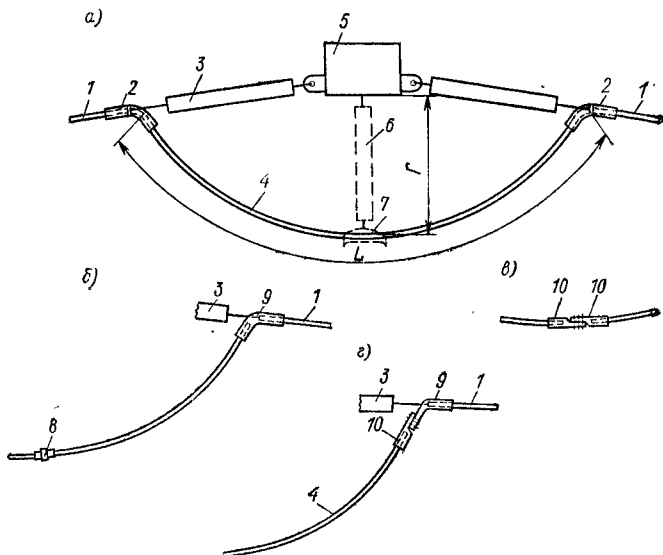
Петли на анкерных и угловых опорах: а — схема петли с неразрезным проводом; б — схема петли с разрезным проводом; в и г — расположение прессуемого болтового зажима в петле
